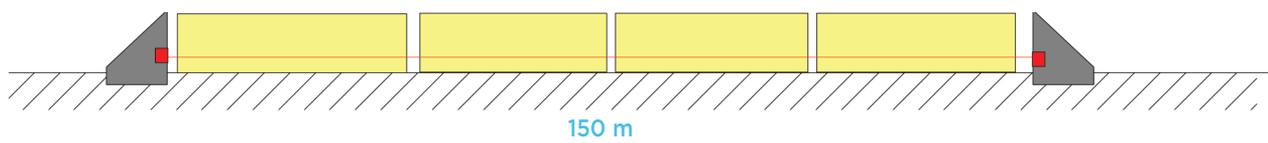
• Exemple de banc de précontrainte en usine (pré-tension).
